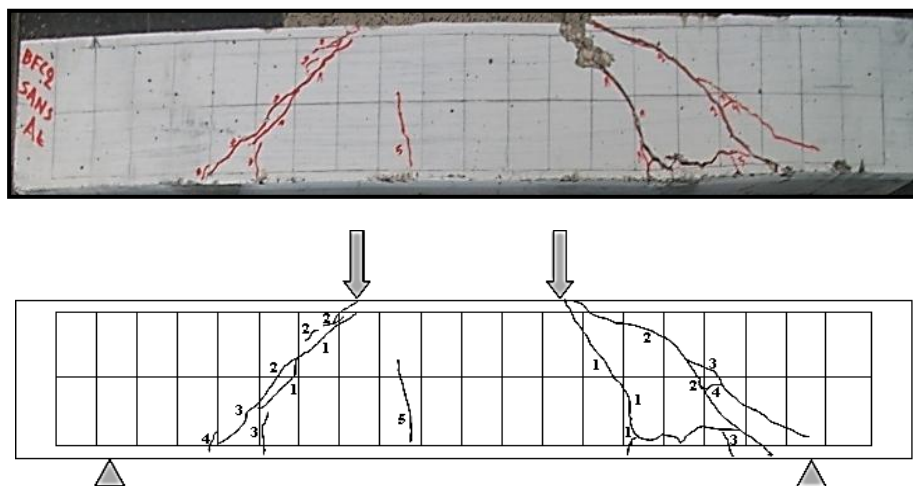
Destruction et fissuration finale de la poutre PBFC2 sans At.
